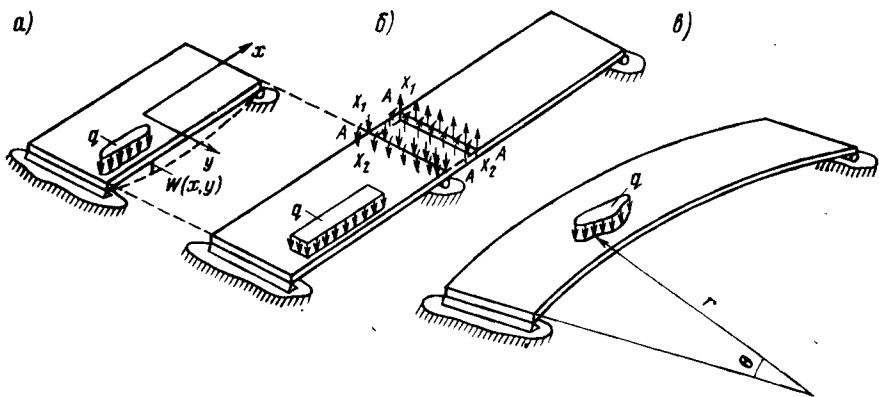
Схемы к расчету плитных пролетных строений как упругих пластинок
